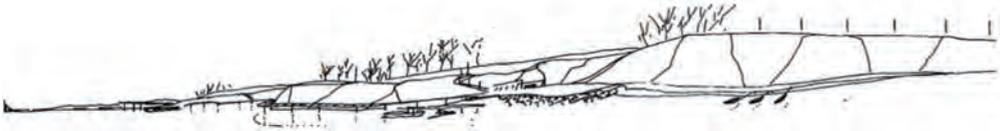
Croquis Paseo del Caminante por el Arq. Gerardo Caballero, 1997 (Fuente: Revista 041 número 12 Arq. Gerardo Caballero. Revista de arquitectura y urbanismo Colegio de arquitectos de la provincia de Santa Fe, Distrito 2. 2021)
